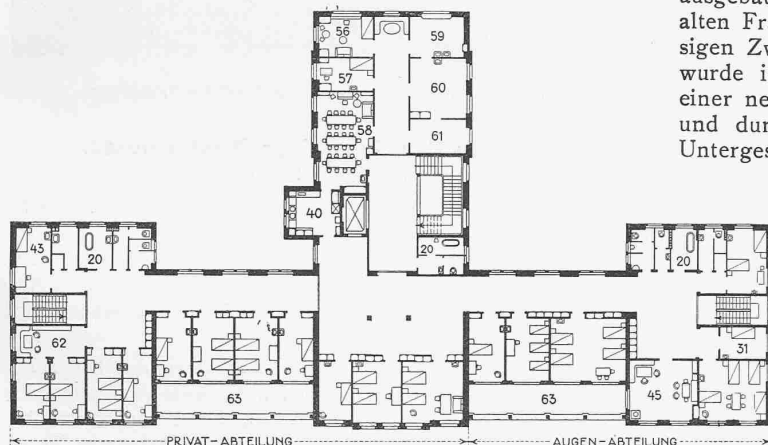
bis 7. Grundrisse, 1:600.
